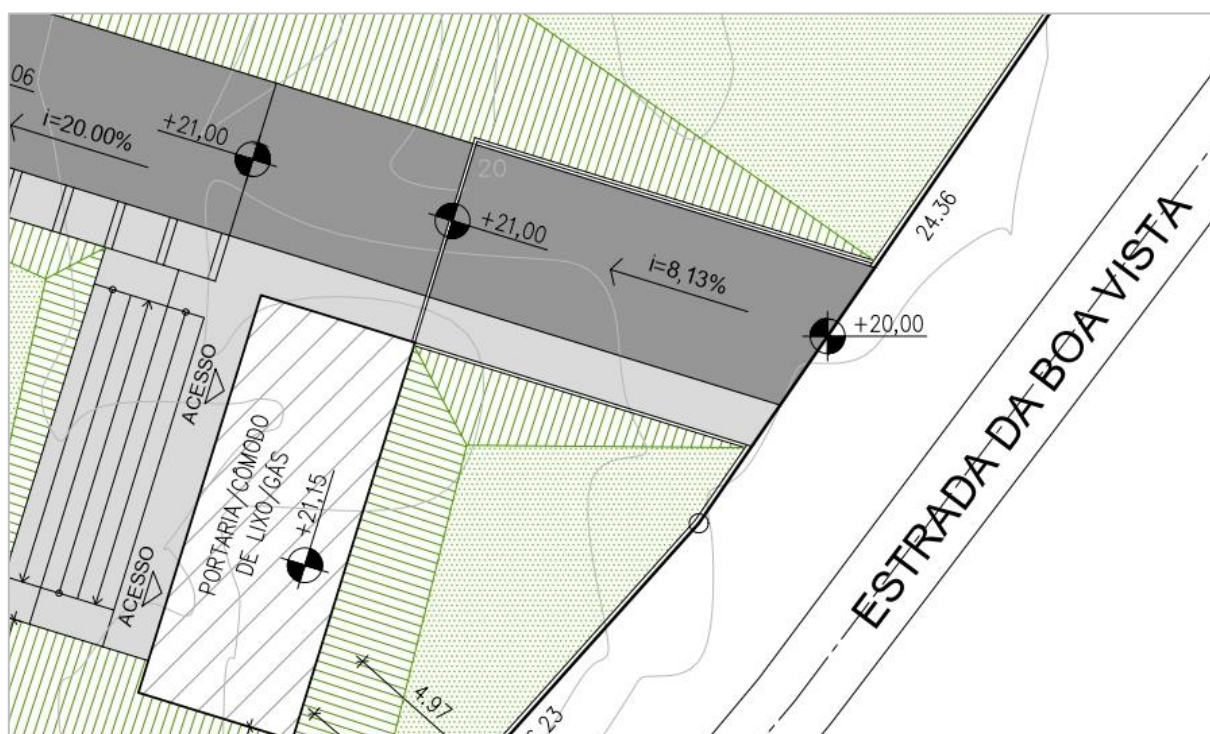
Recorte planta de implantação evidenciando a portaria (Residencial Boa Vista 2).
